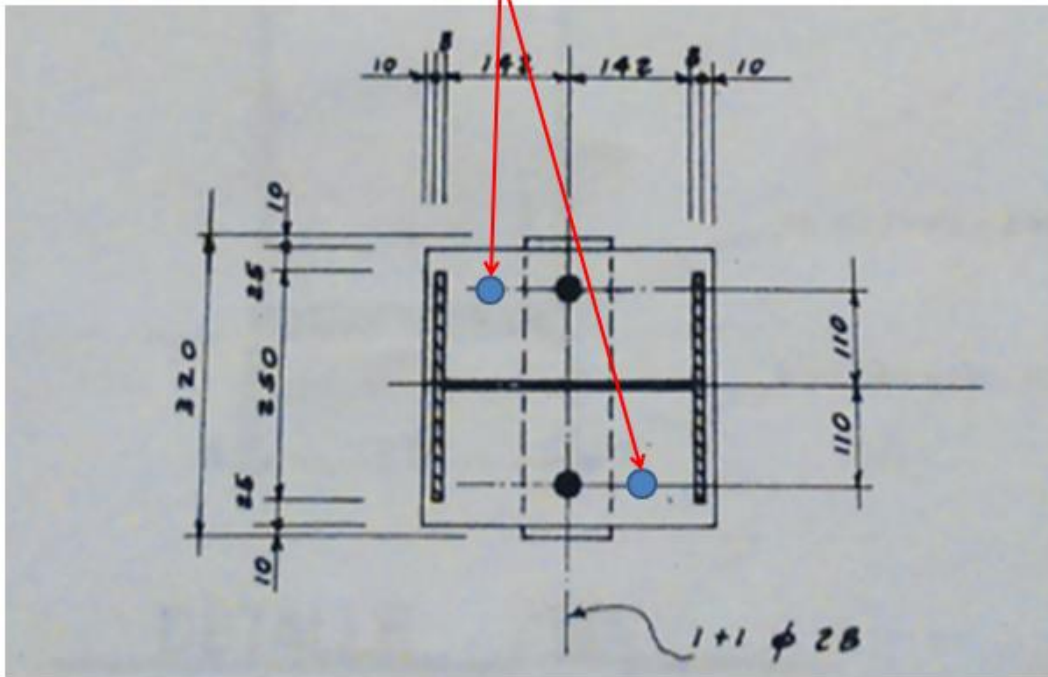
Vista en planta disposición pernos refuerzos placa base.
